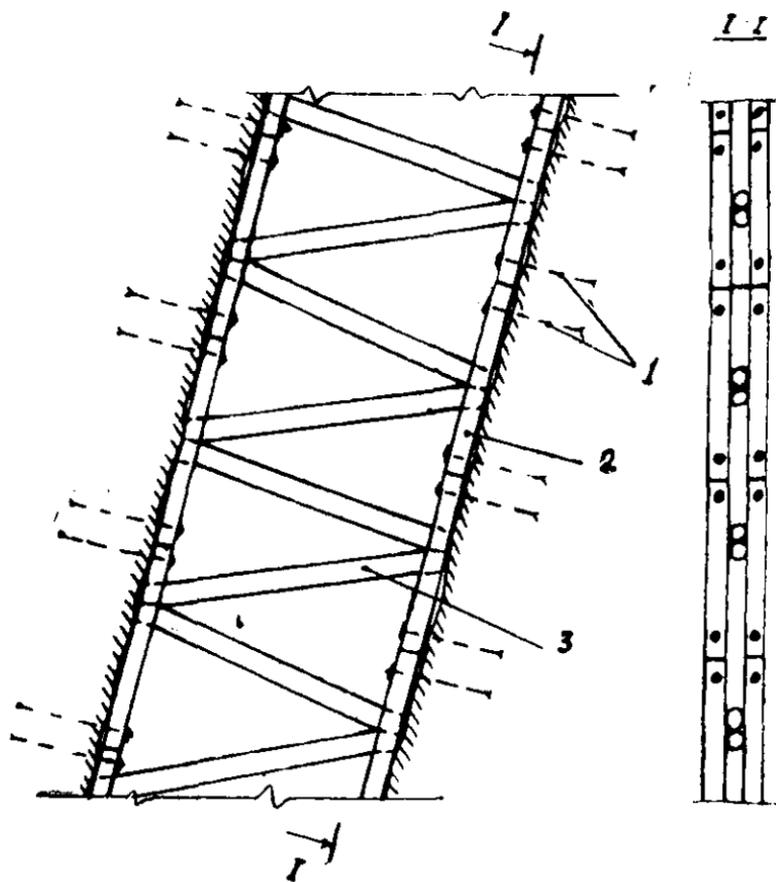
Крепление флангового восстающего распорками стандартной длины: 1—анкерные болты; 2—вертикальные брусья; 3—распорки.
